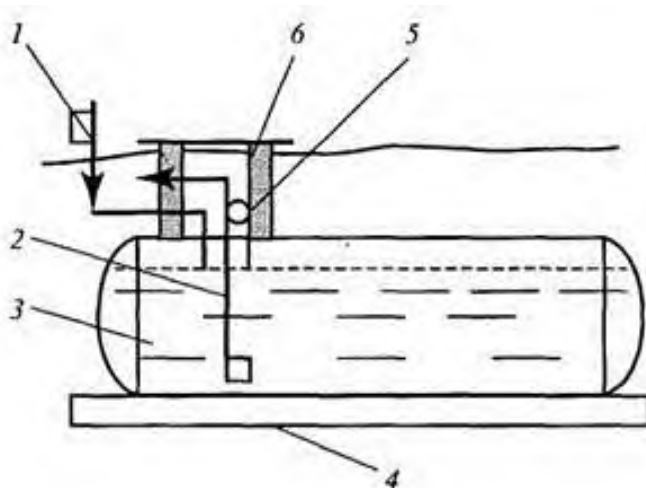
Горизонтальный подземный цилиндрический резервуар:
